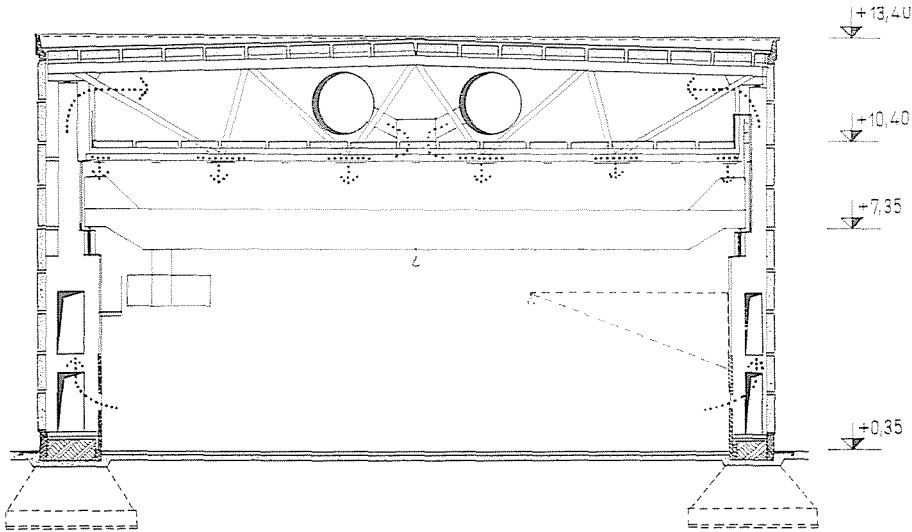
Schnitt durch die Werkhalle der Präzisionswerkzeugmaschinenfabrik Csepel (Entwurf: Technische Universität Budapest)
